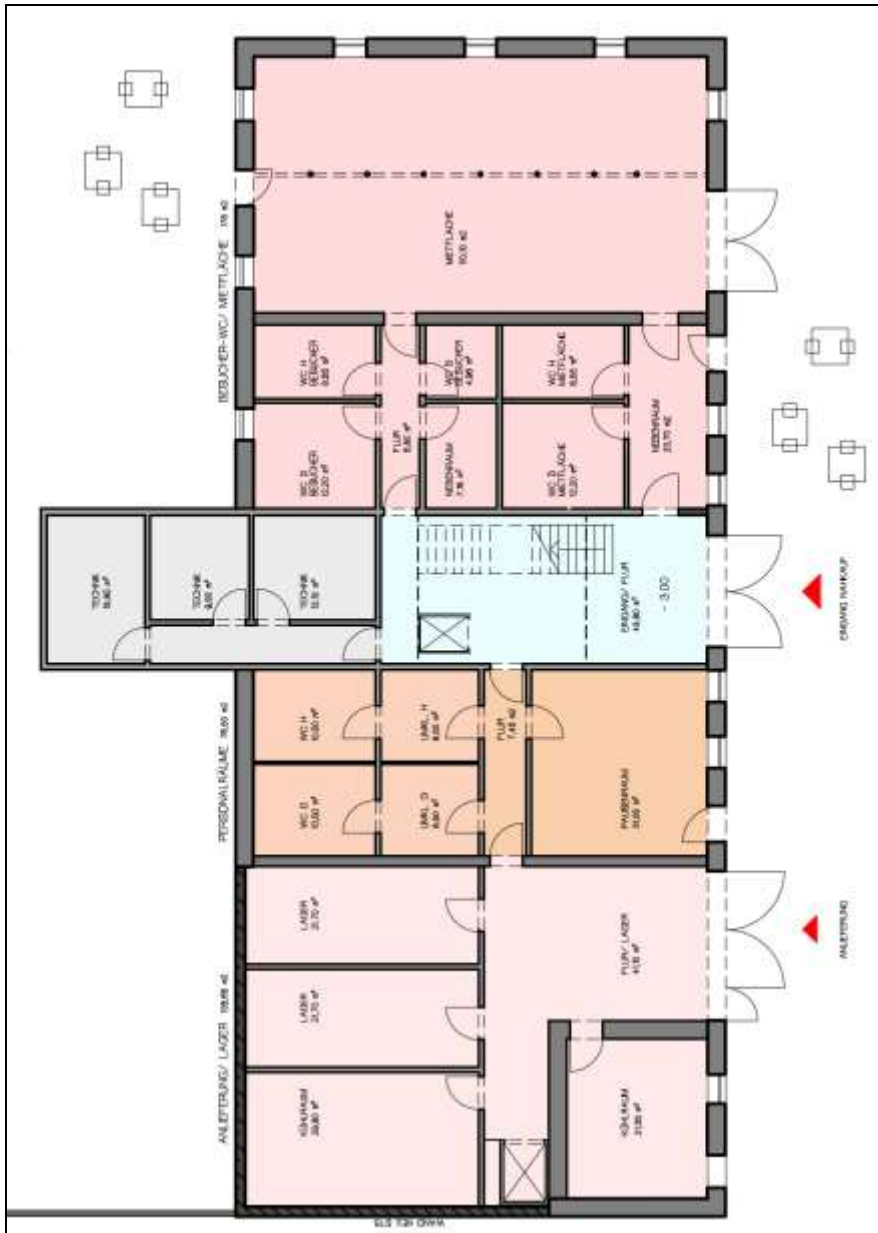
"Schnitzerstadel" - Auszug Grundriss EG gemäß Vorentwurf [a]
